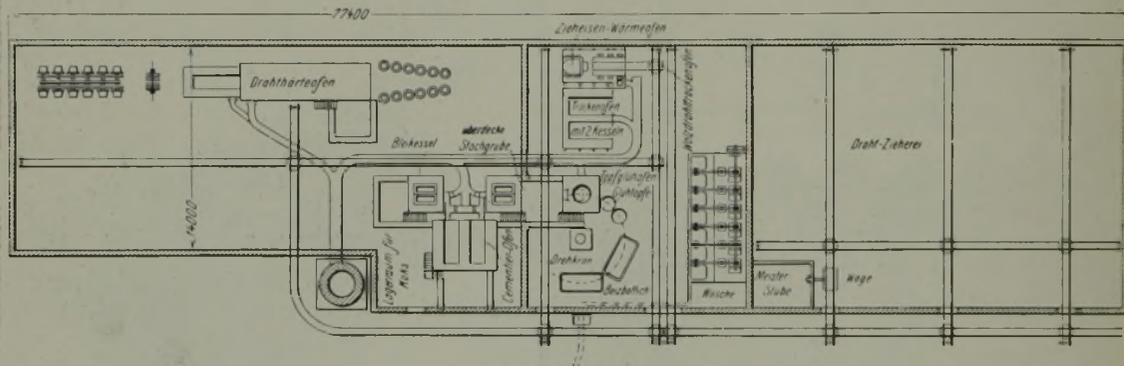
Plan einer Stahldrachfabrik für Seildrähte von Möhl & Co., Dellbrück.
